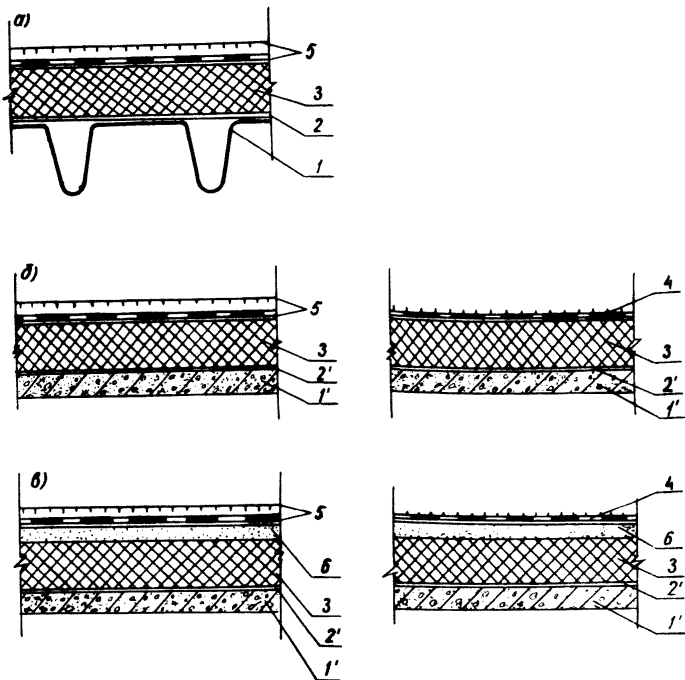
Конструкции ограждающей части покрытий зданий с несущими профилированными стальными настилами (а) и с железобетонными или легкобетонными плитами (б, в) 1 - несущий настил; 1 - несущие плиты; 2 - парогазоизоляционный слой из рубероида (определяет с я проектом); 2 - слой битума; 3 - пенополистирольные плиты; 4 - кровля с верхним слоем из рубероида с крупнозернистой посышкой; 5 - кровля с защитным слоем из гравия, втпленного в кровельную мастику (определяется проектом); 6 - основание под кровлю из цементно-песчаного раствора
